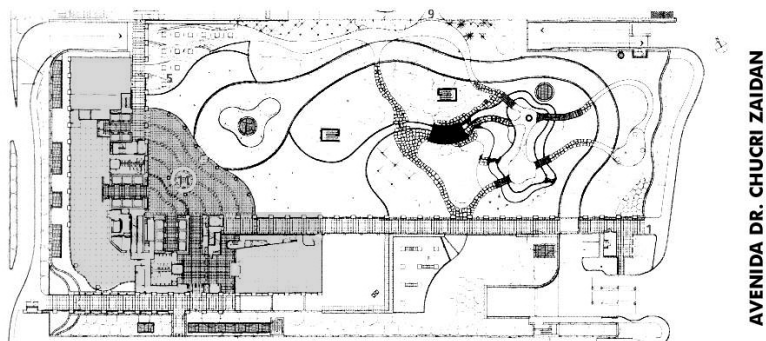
Planta piso térreo e jardim (Fonte: Revista Projeto 269, 2002)
